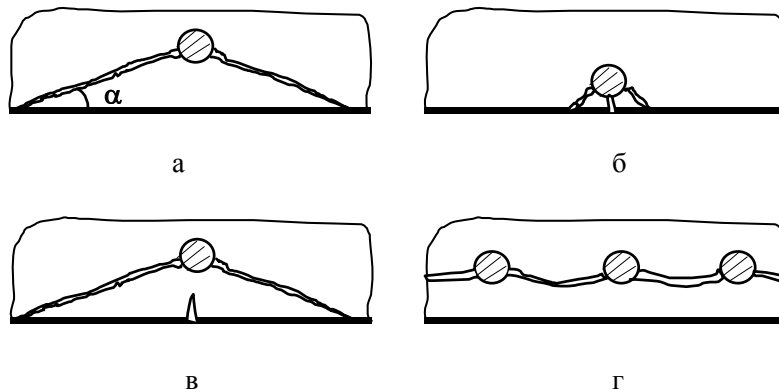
Схеми руйнування бетону внаслідок корозії арматури
